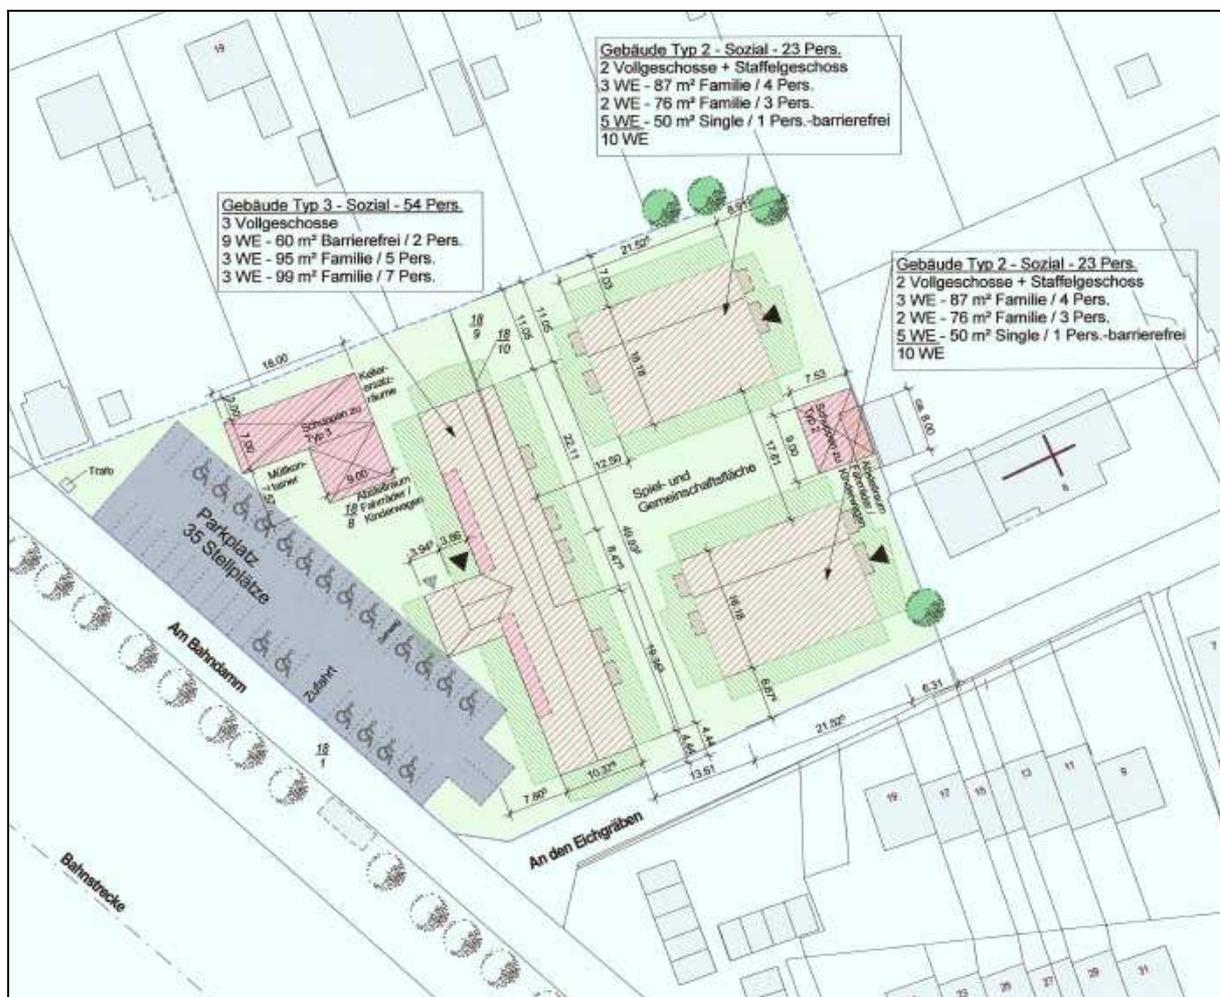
Lageplan und Konzept für die geplante Bebauung
